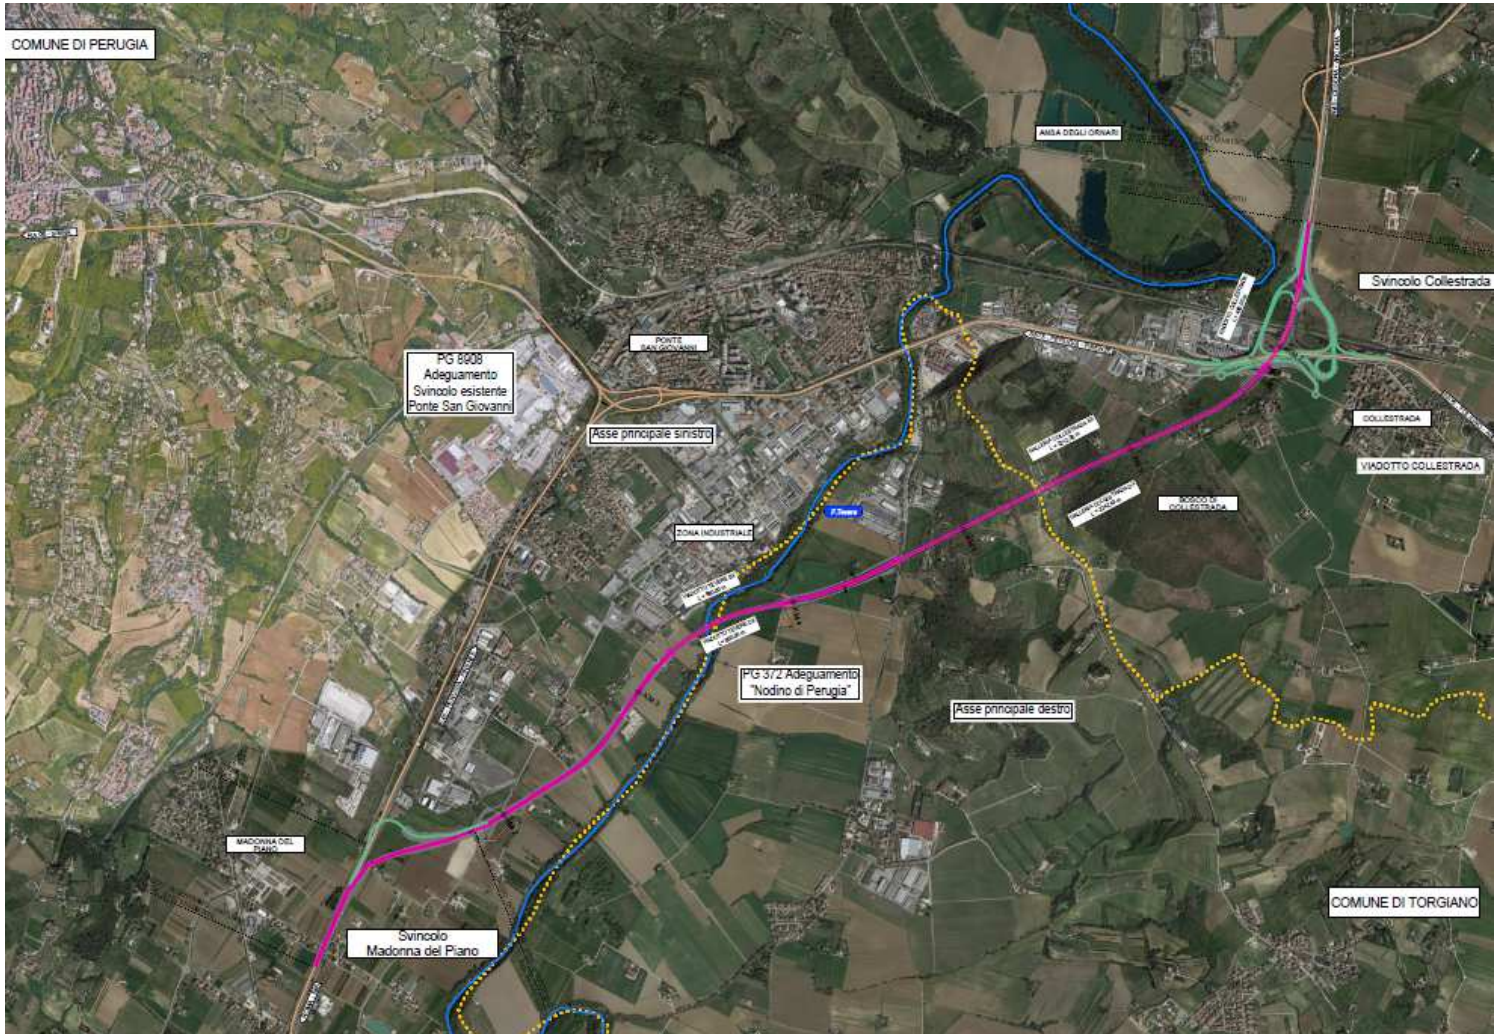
Localizzazione del Progetto Definitivo - Tratto Madonna del Piano – Collestrada su base ortofotografica
